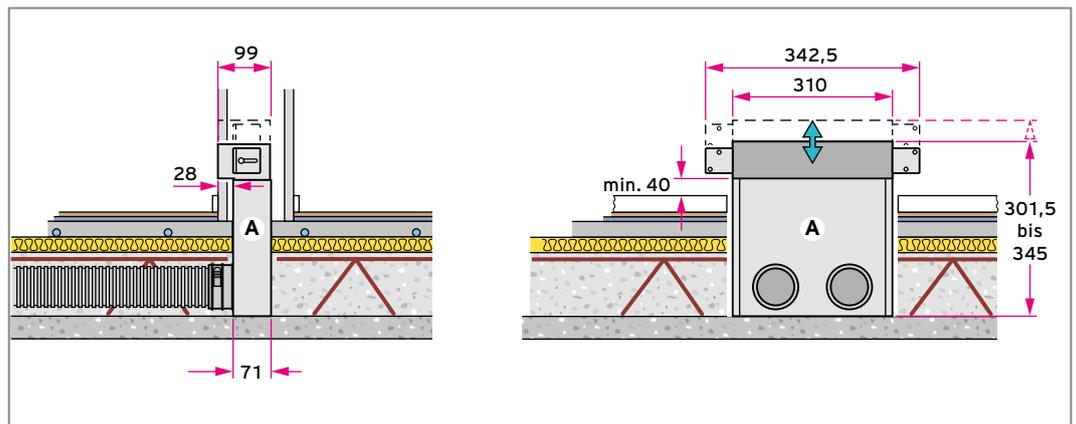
Rechteckiger Luftauslass, Wandmontage - Verlegung in der Rohbetondecke
